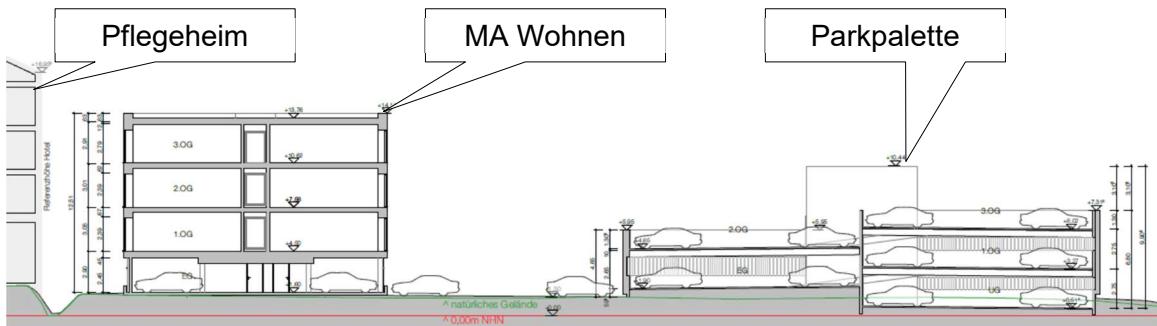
Geplante Parkpalette im Schnitt, Quelle: b)
